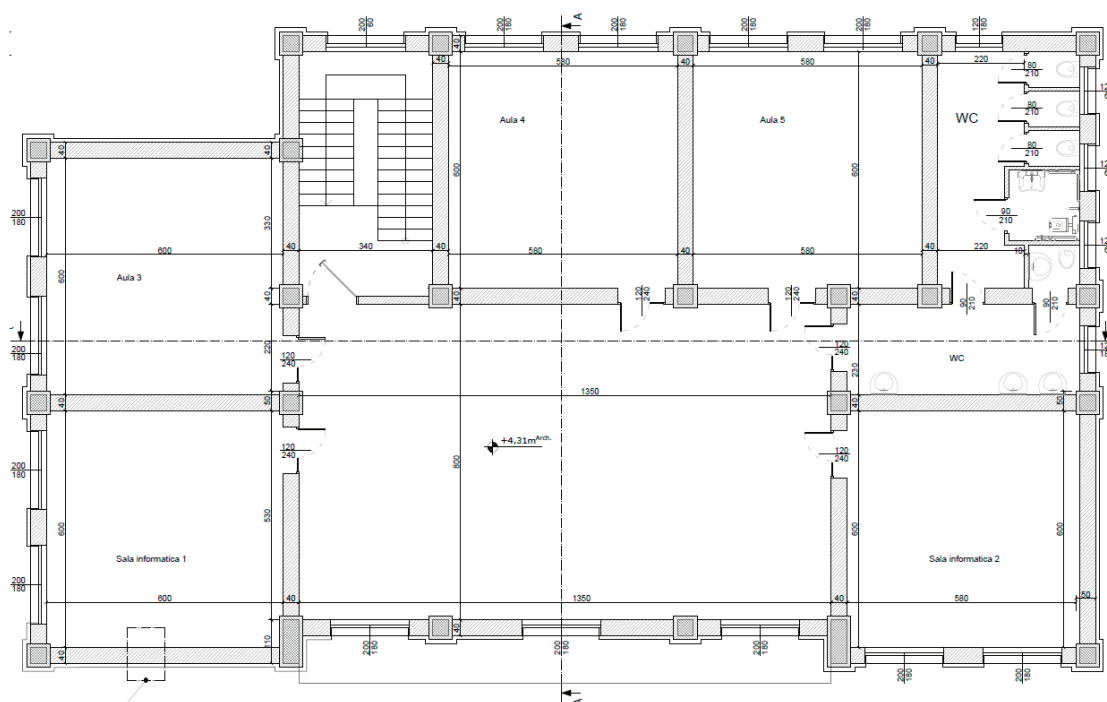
Pianta Piano Primo- Stato Futuro
